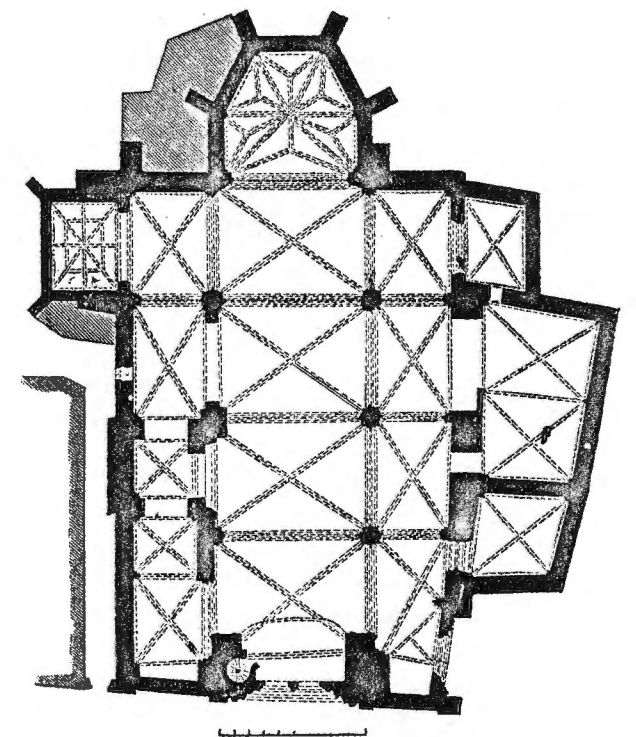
Plan de l'église Saint-Pierre avant sa reconstruction.
